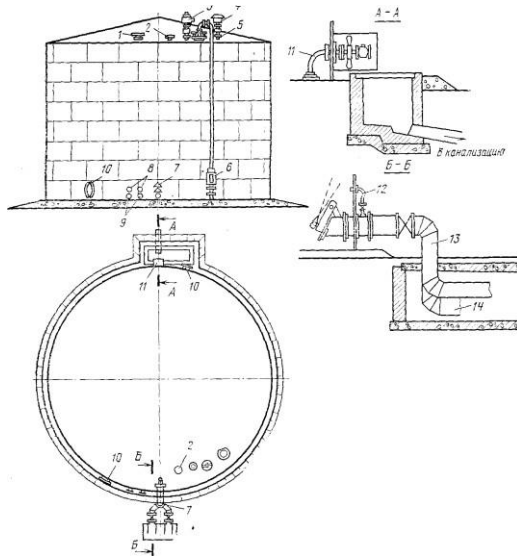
Металлический (сварной) наземный резервуар для хранения дизельного топлива
